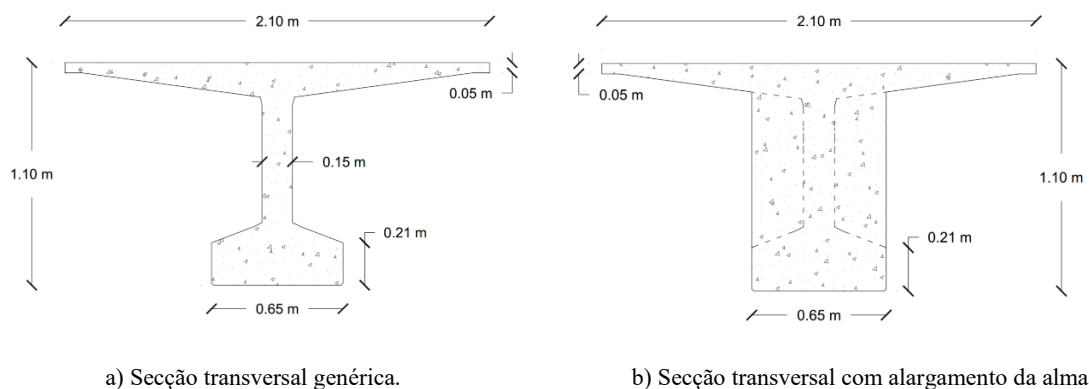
Secção transversal da viga T adotada para o modelo numérico.
